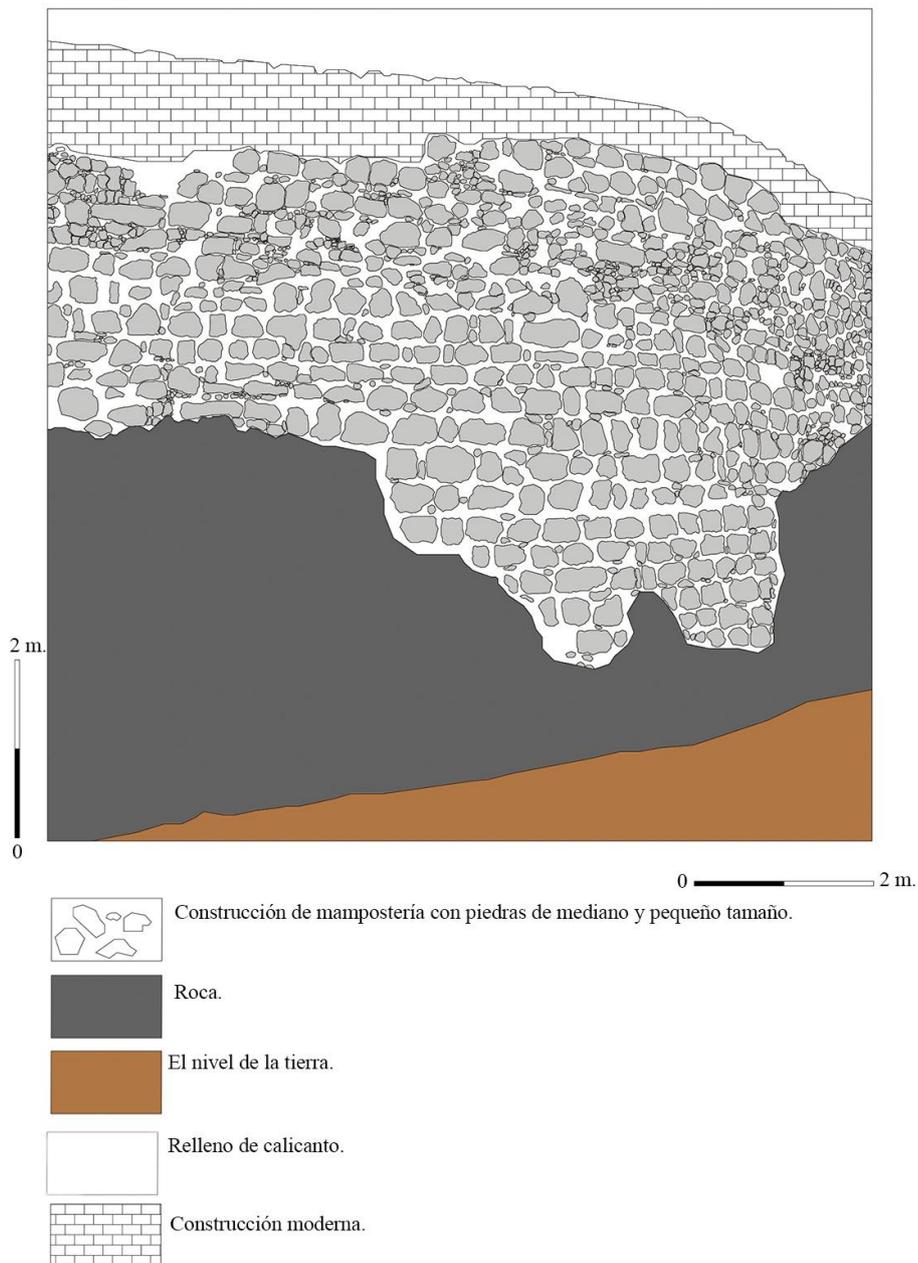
El lienzo (L_21) en la cara este. La técnica constructiva, mampostería irregular. (Elaboración propia)
